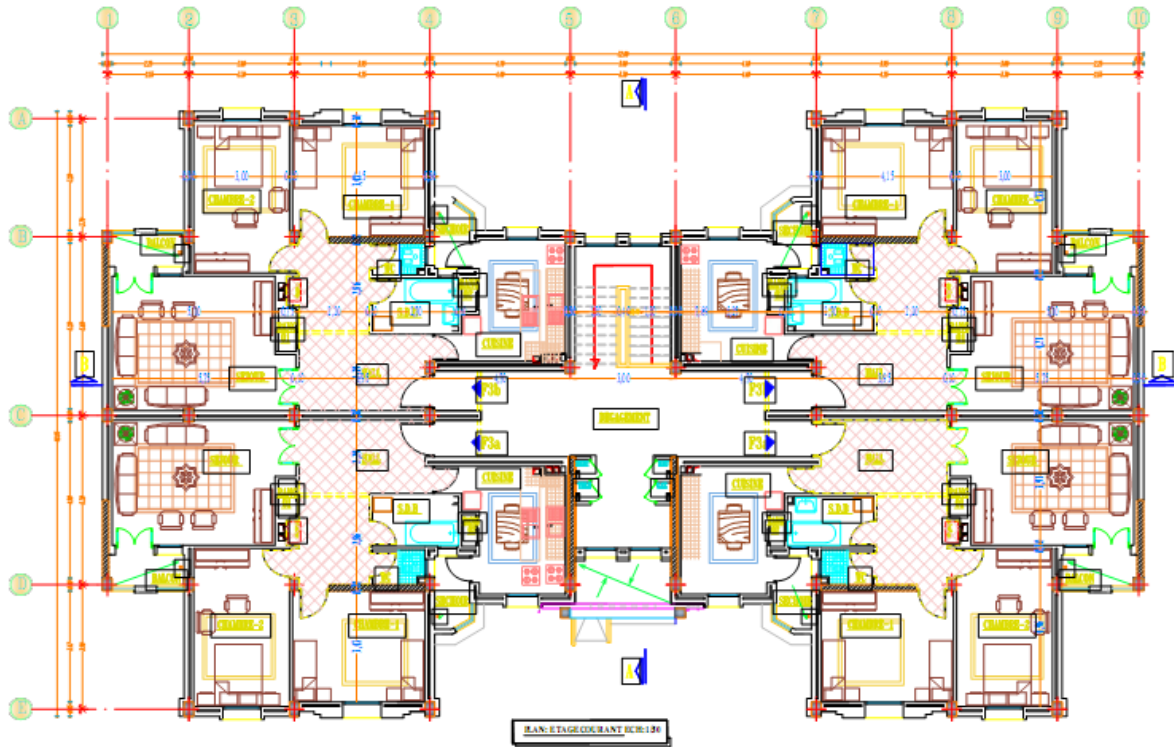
Plan d'étage courant (1er étage, 2eme ,3eme et 4eme).
